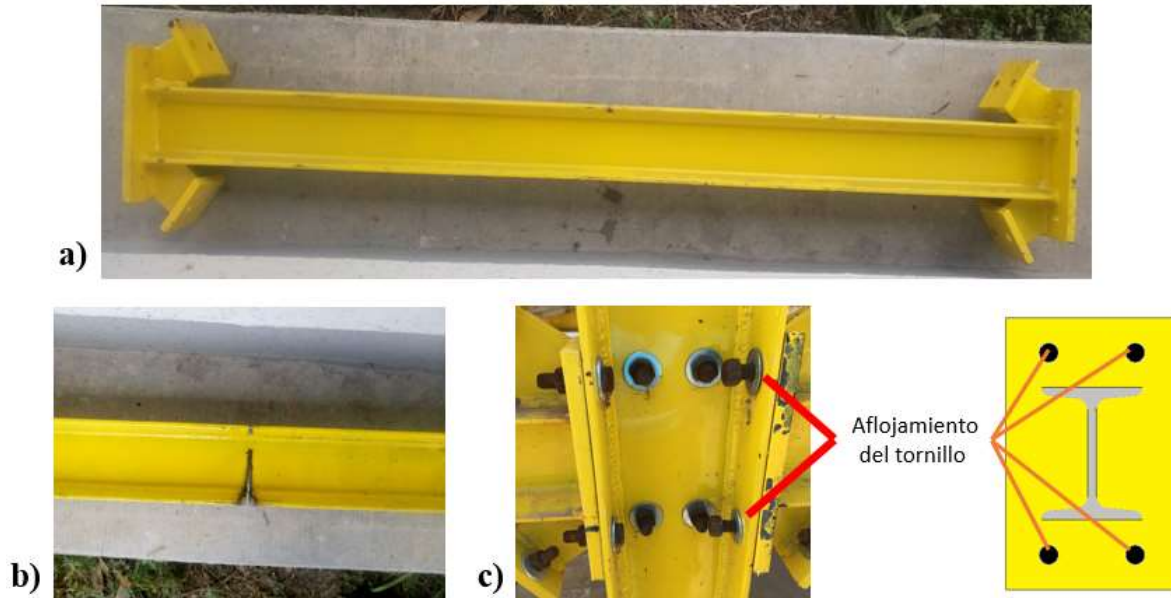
Condiciones de daño bajo estudio. a) Viga sana, b) Viga con grietas por fatiga, c) Aflojamiento de uniones.
